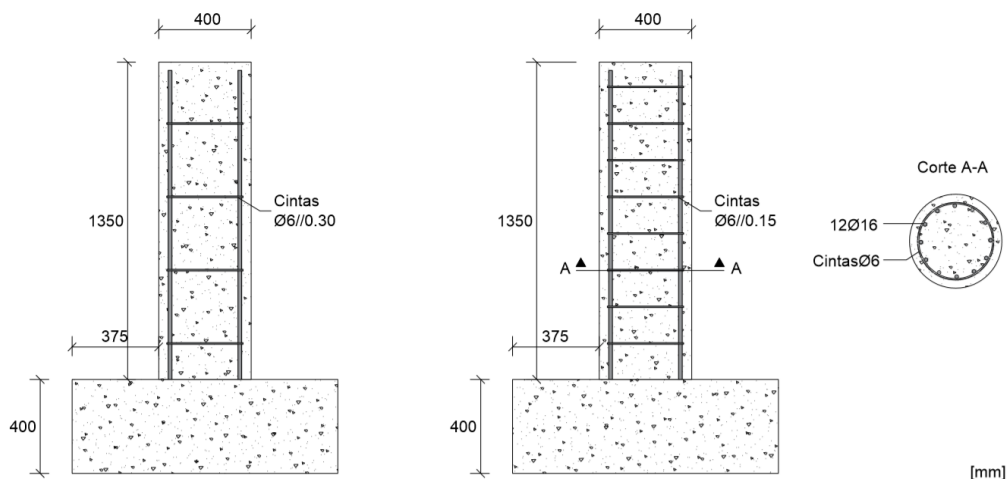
Características geométricas e pormenorização das armaduras dos pilares (adaptado de Gallardo-Zafra e Kawashima [26])
